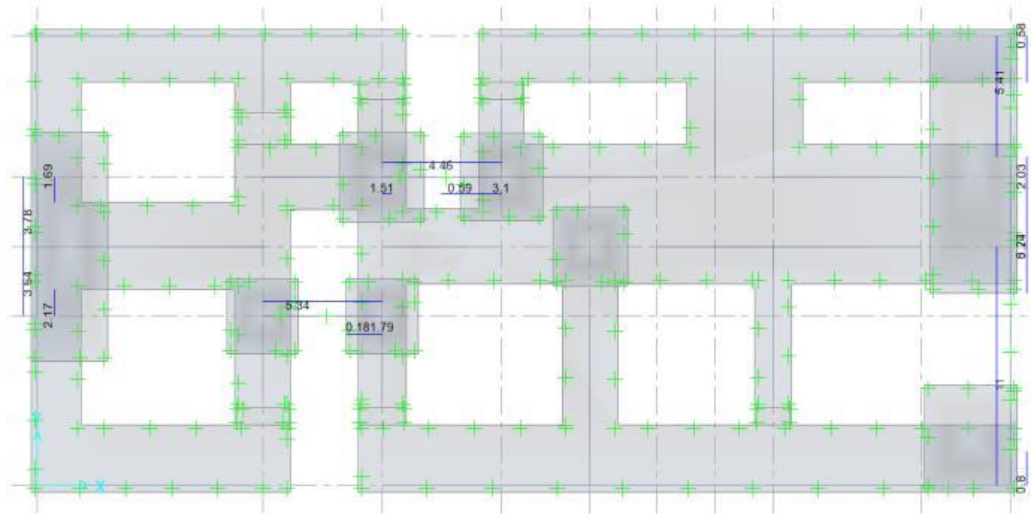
Distribución de acero Longitudinal en las Vigas de Cimentación (cm²)
